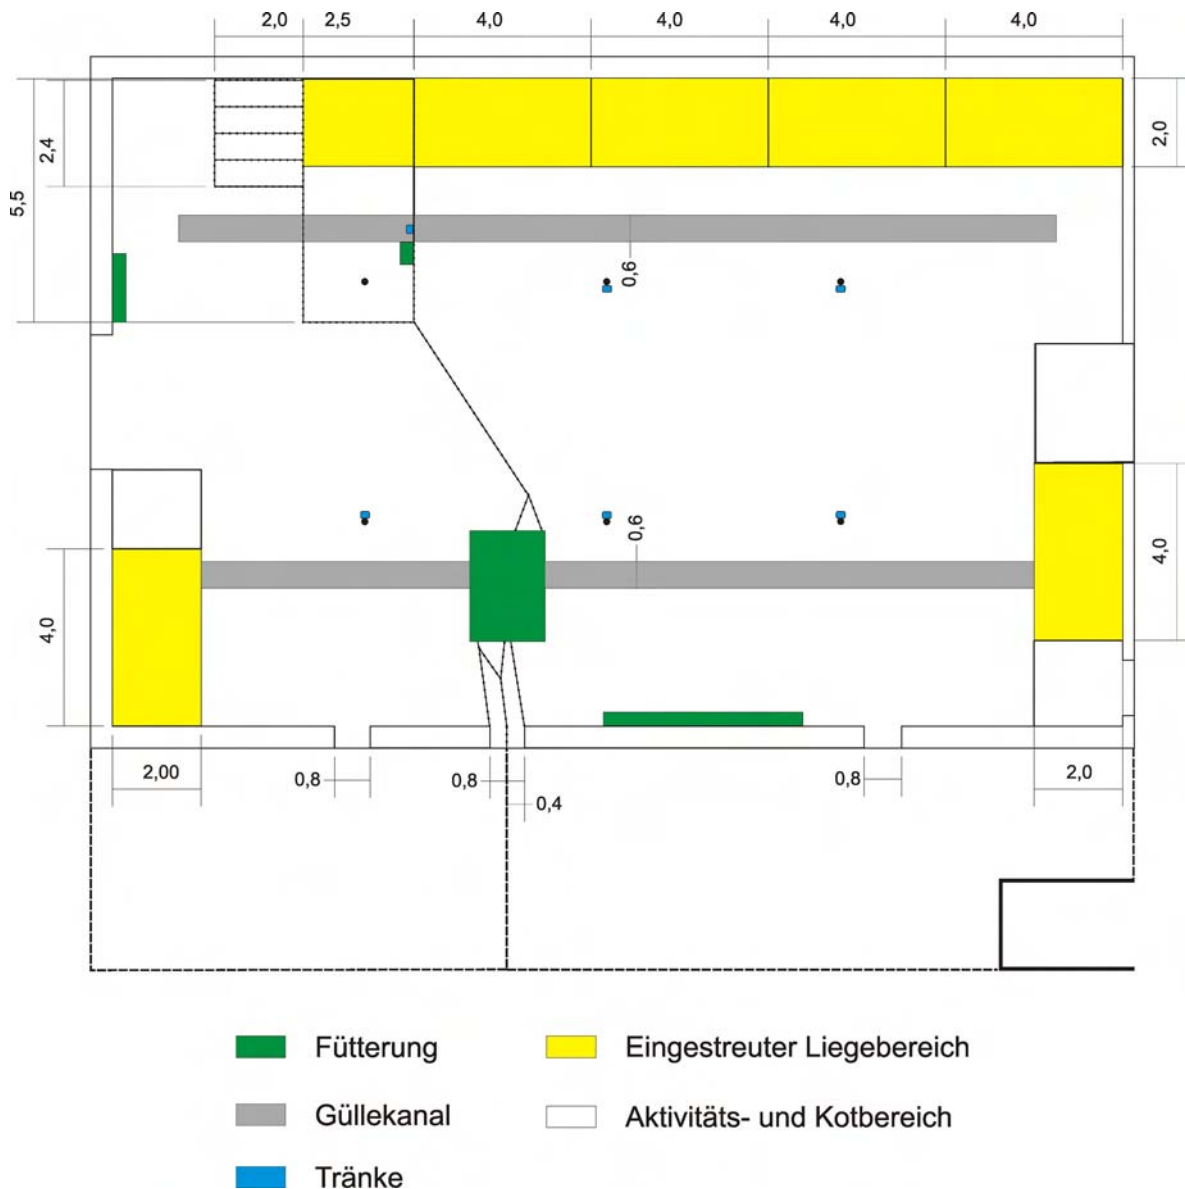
Grundriss Eingliederungs- und Wartebereich für tragende Sauen (Angaben in m)
